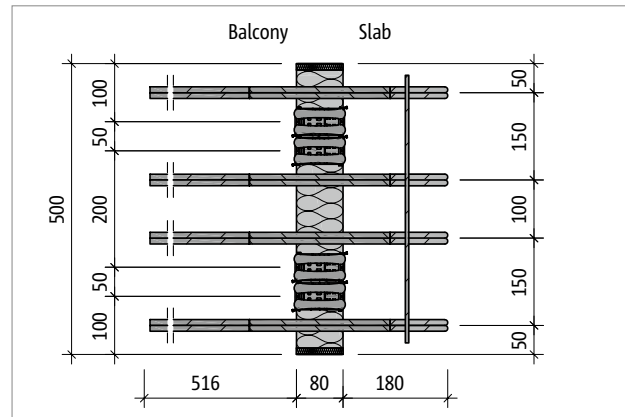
Schöck Isokorb® type Q-E-W-VV5: Product layout
